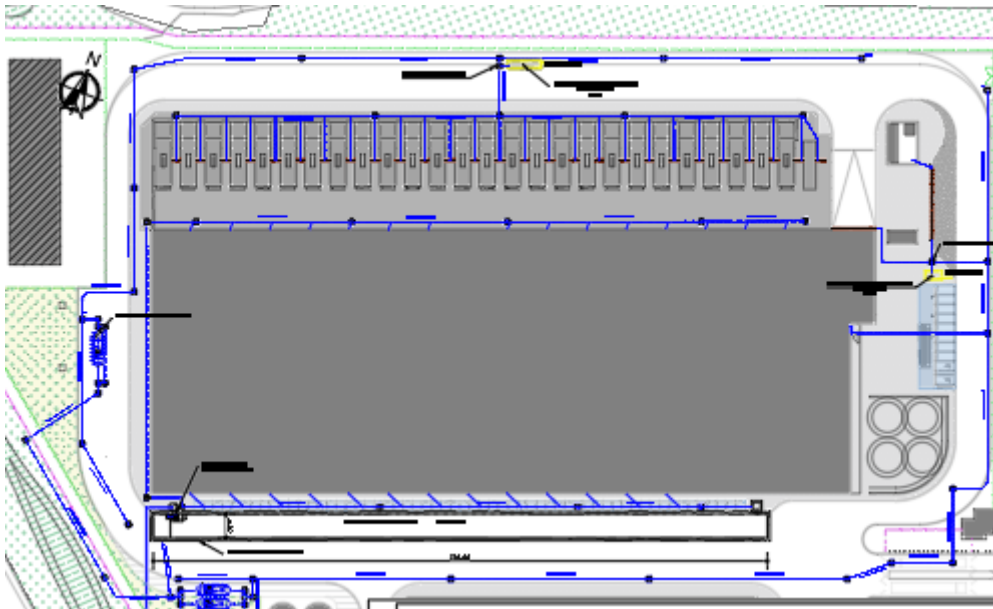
Planimetria rete di collettamento delle acque meteoriche interne all'area di progetto
